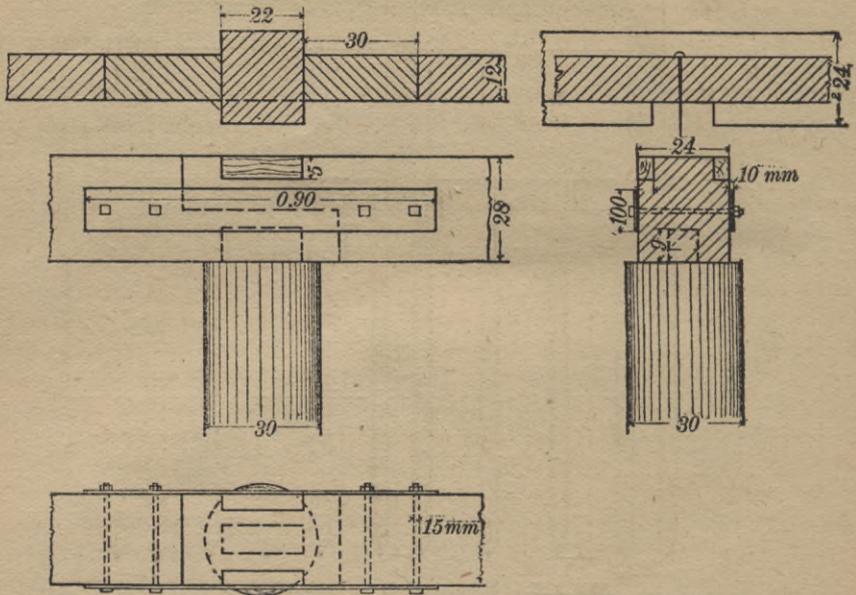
Gerader Schwellenstoß mit Zangen und Bohlen.
